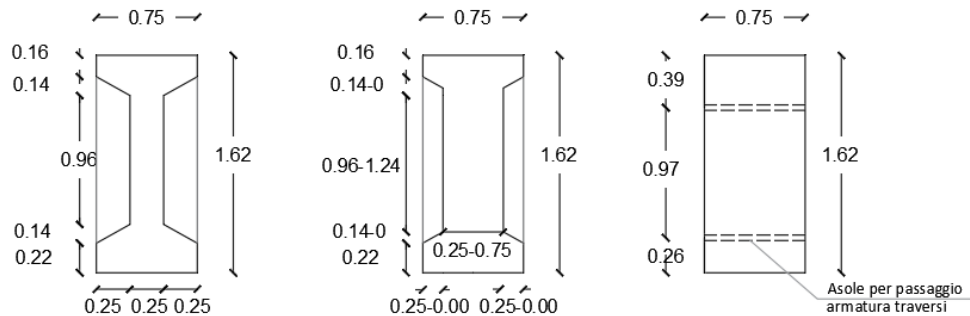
Geometria trave, da sx: sezione a doppio T; sezione variabile all'estremità; sezione rettangolare
